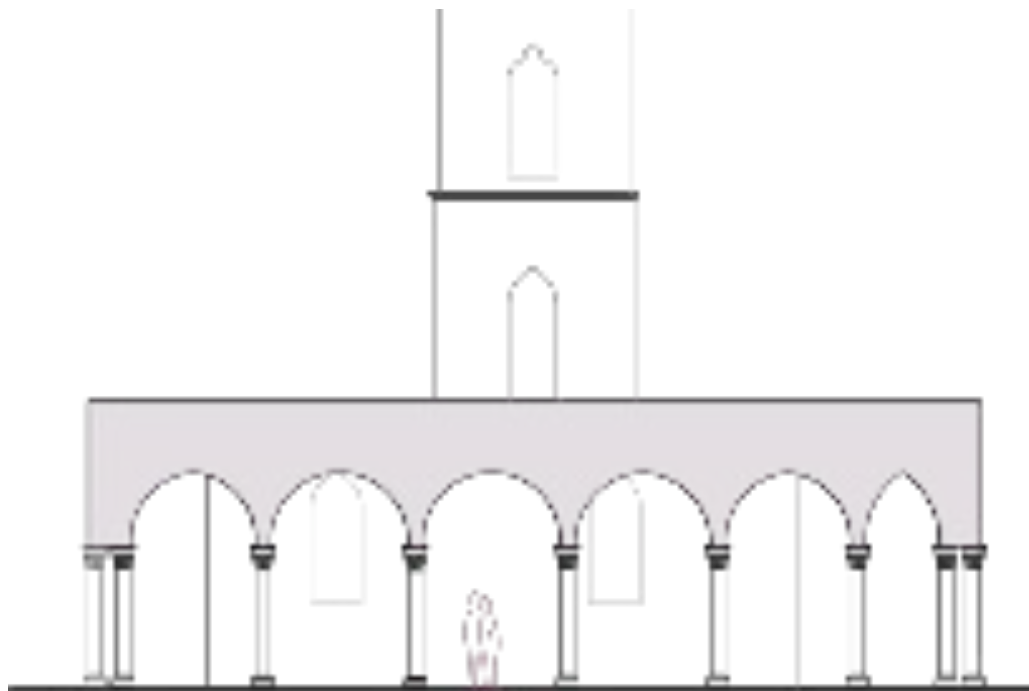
Arquería de la fachada norte del baño turco. Con arcos de medio punto y ojival.
